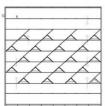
Panel de acero reciclado y perforado Edificio complejo deportivo, Medellin – Plan B, Equipo Mazzanti Fuente: Archidaily (2022)
